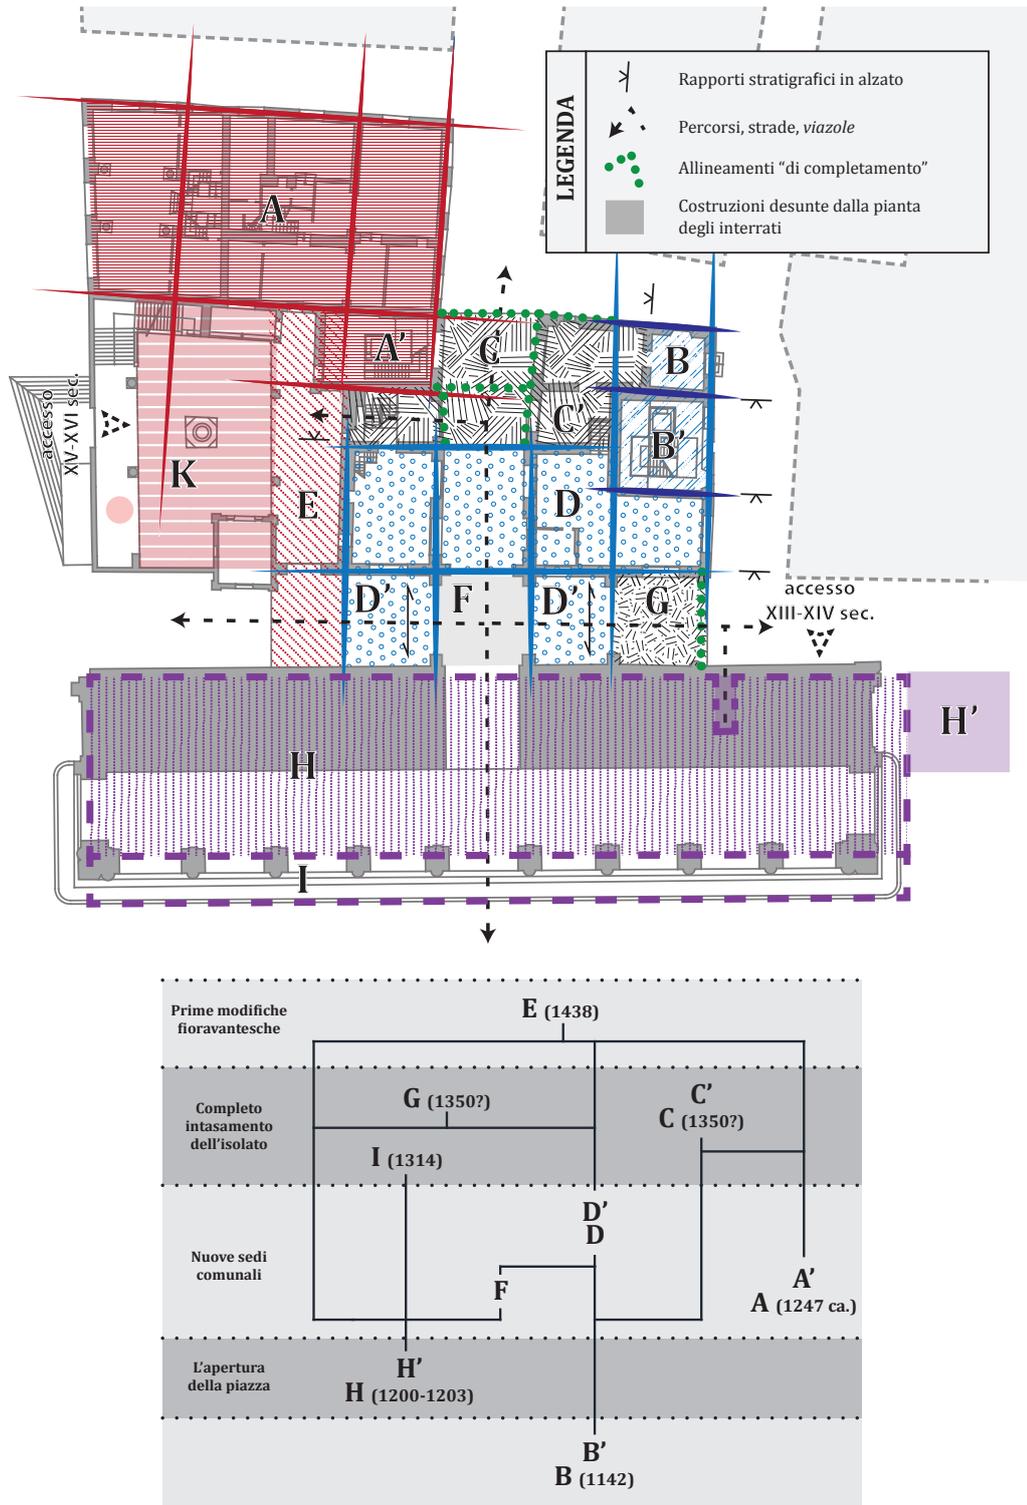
Ipotesi di sviluppo planimetrico del complesso.
